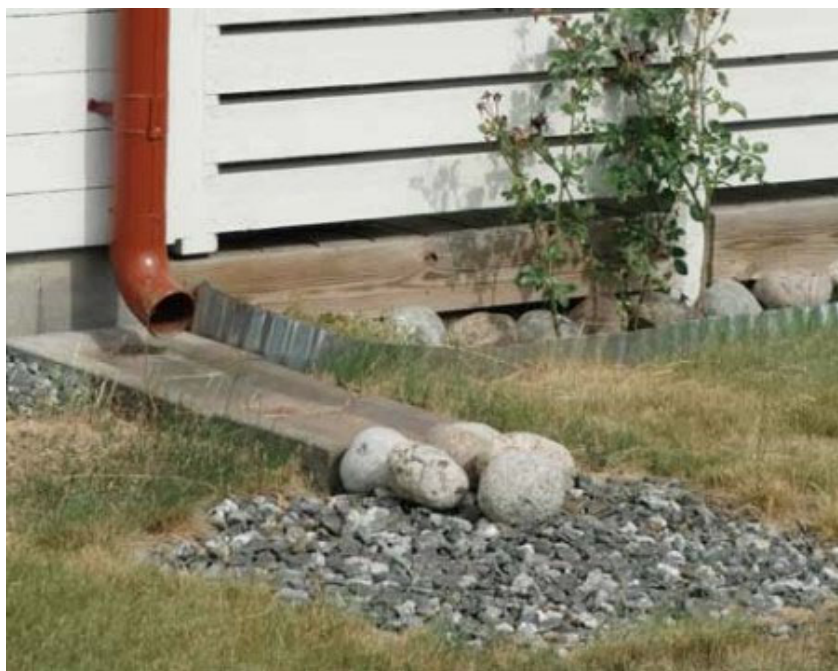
Föreslagen dagvattenhantering genom en avrinningsplan.
